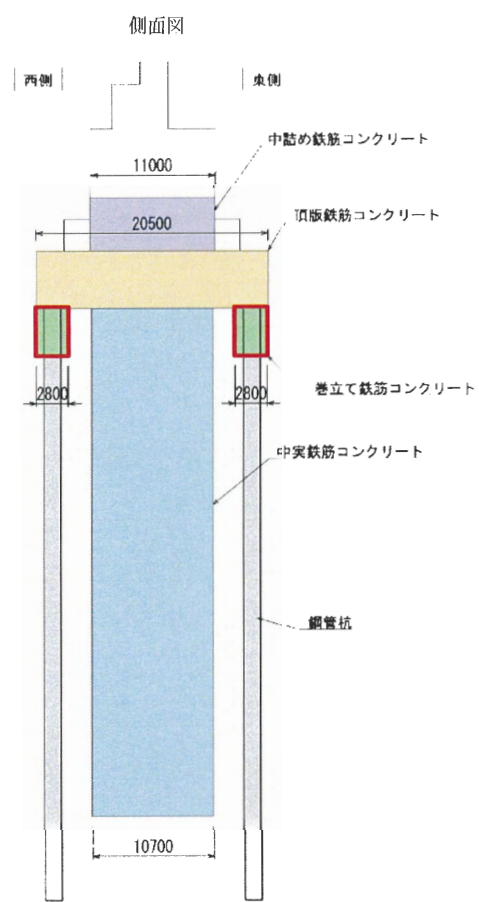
巻立て鉄筋コンクリートの配筋図
